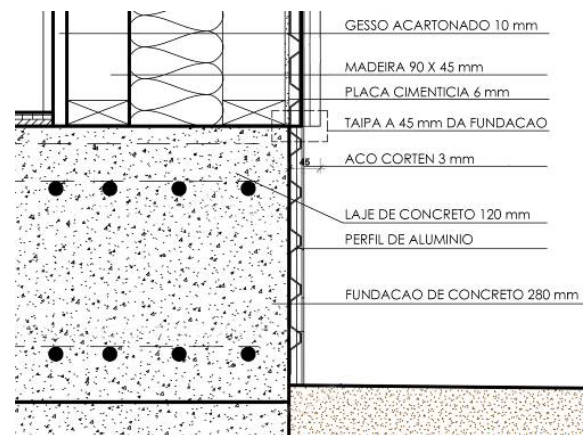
Detalhe da fundação de concreto com a taipa a 45 mm da face do concreto
